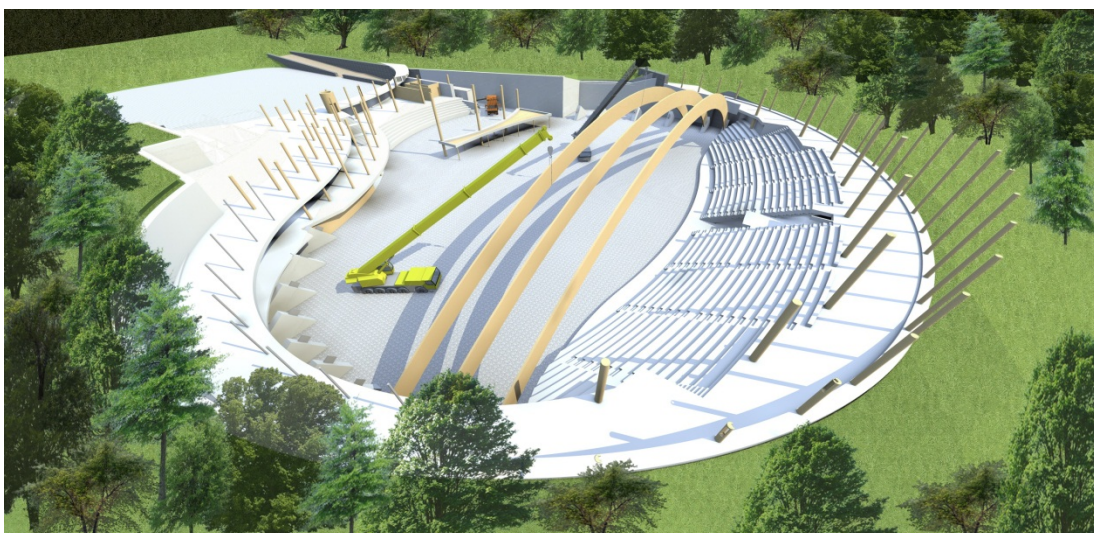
FASE DI CANTIERE – MONTAGGIO ARCHI 1
